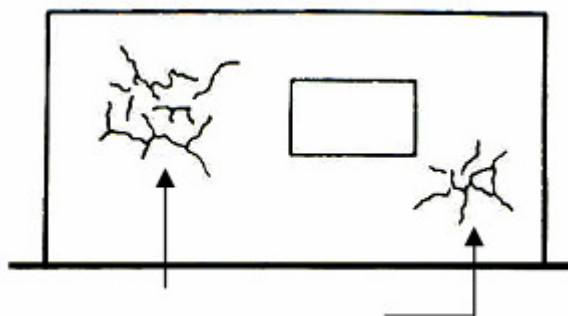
fissuras causadas pela retração da argamassa de revestimento (DUARTE, 1998, p. 21)
